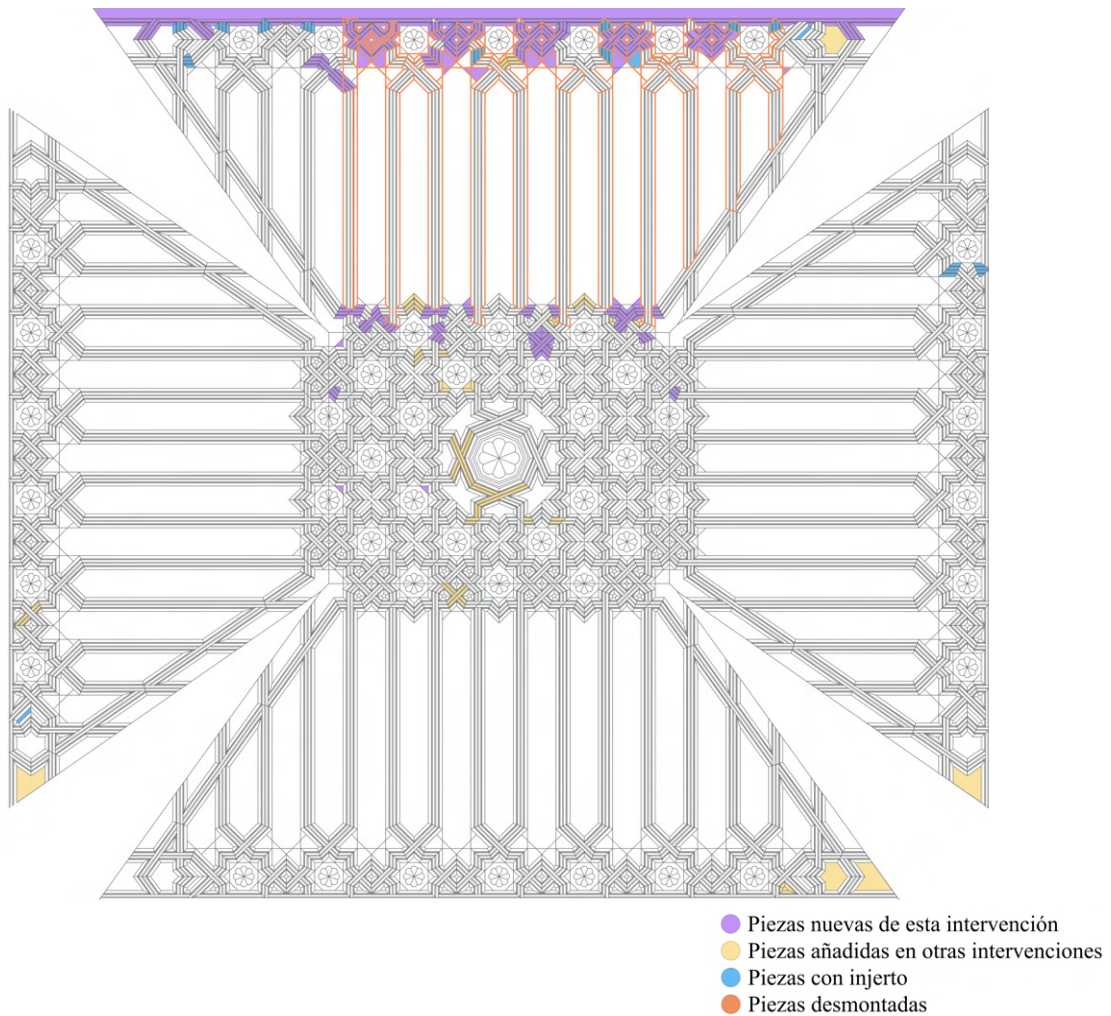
Modelado 3D. Intervención en la armadura interior de la cubierta (anverso).
